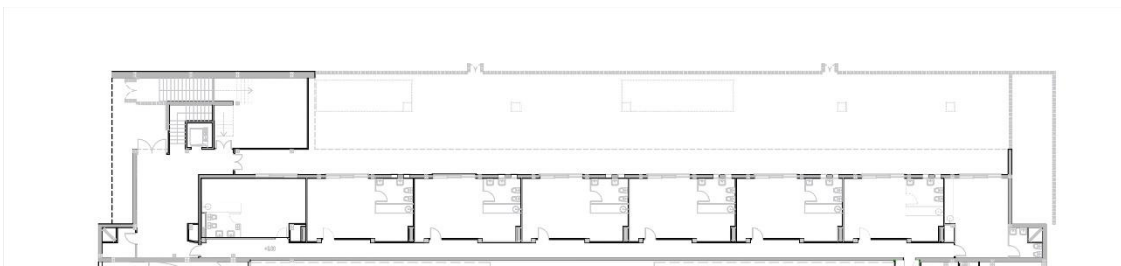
Planimetría general de la guardería elaborada a partir de los planos de la Universidad de Sevilla.
